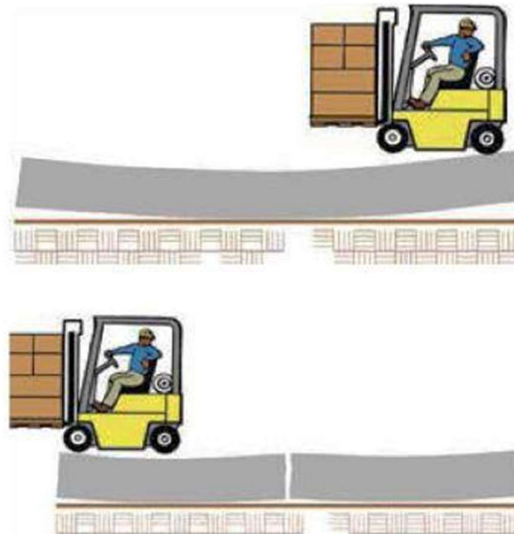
Fissura causada pela combinação de *curling* e das cargas a que o pavimento é sujeito
